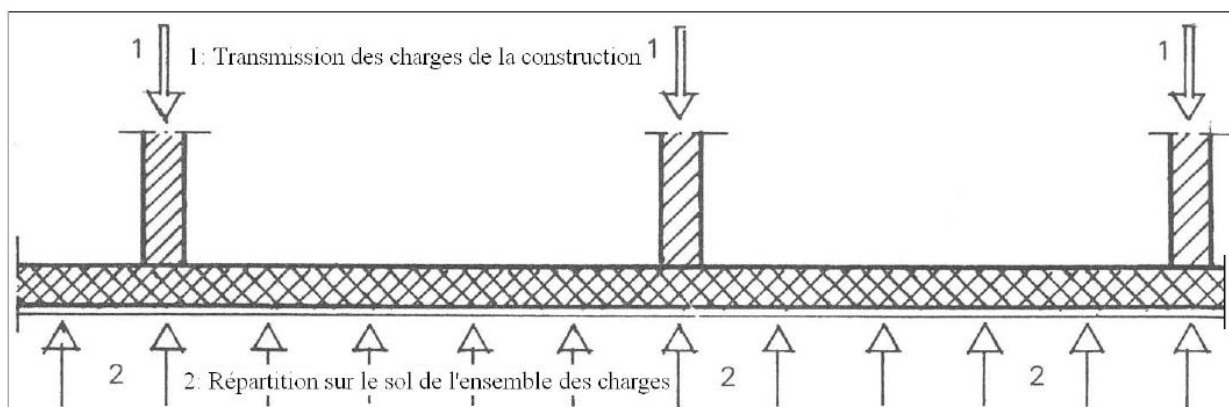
Fondation sur radier (d'après Ersnt Reuter)
